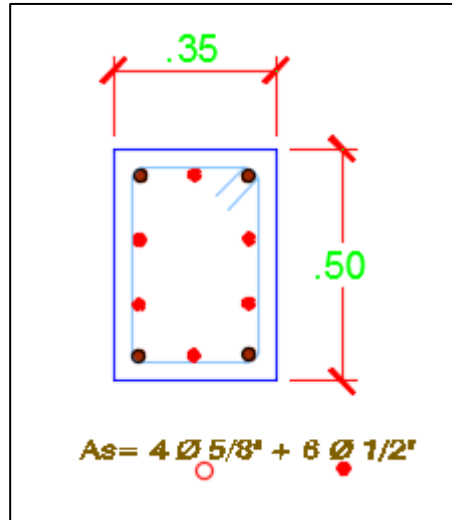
Sección Transversal Columna C-1 y-y. Fuente: Elaboración propia.
